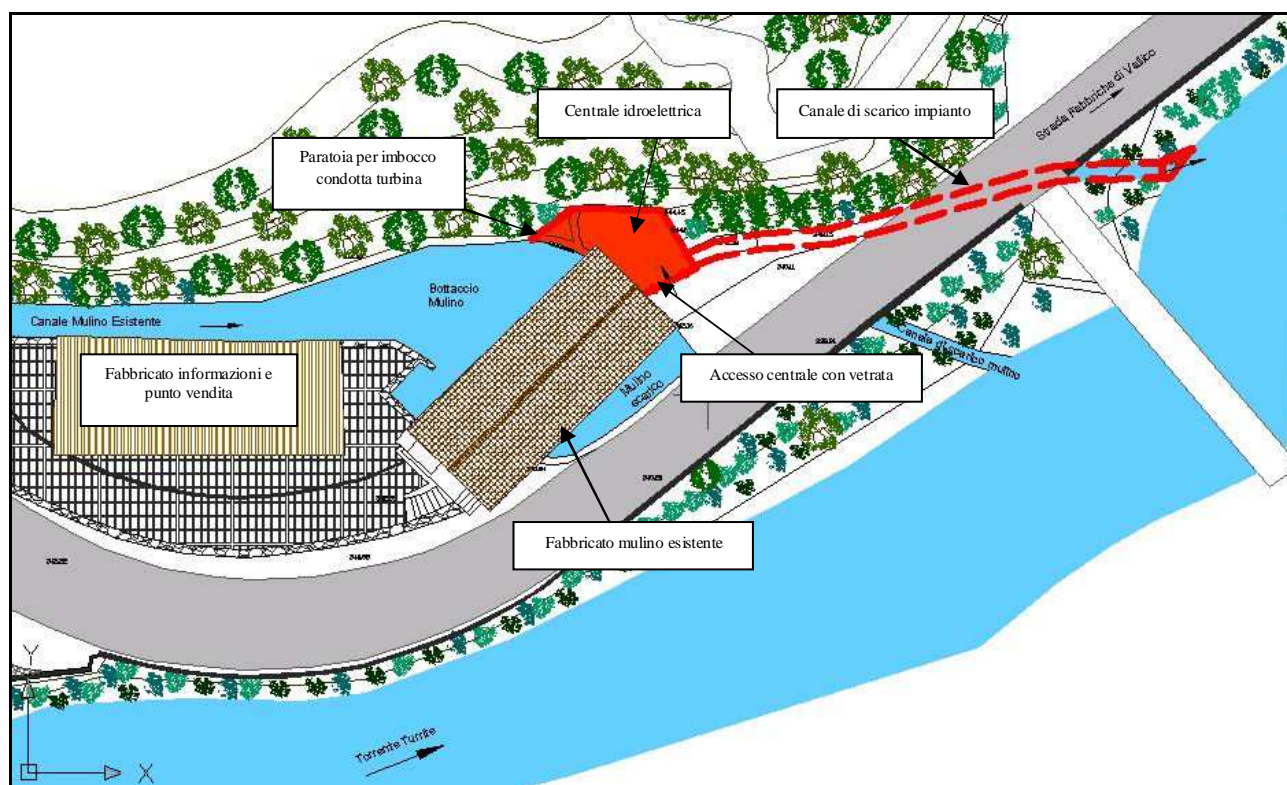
stralcio planimetrico zona centrale idroelettrica e canale di scarico.
